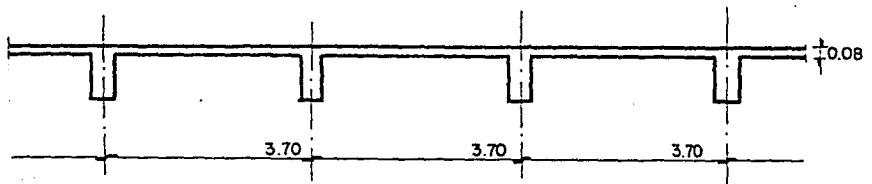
Corte longitudinal del sistema de traveses y losas de concreto armado.
